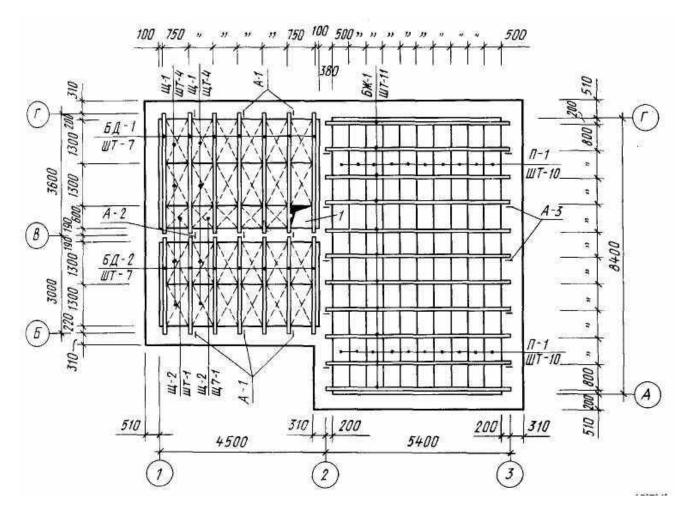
Пример выполнения перекрытия по деревянным балкам
